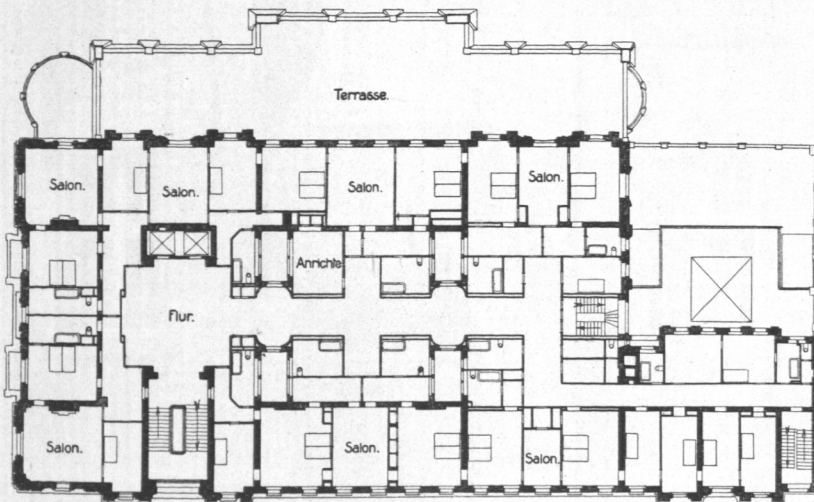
Hotel Esplanade, Obergeschoß, Grundriß.
